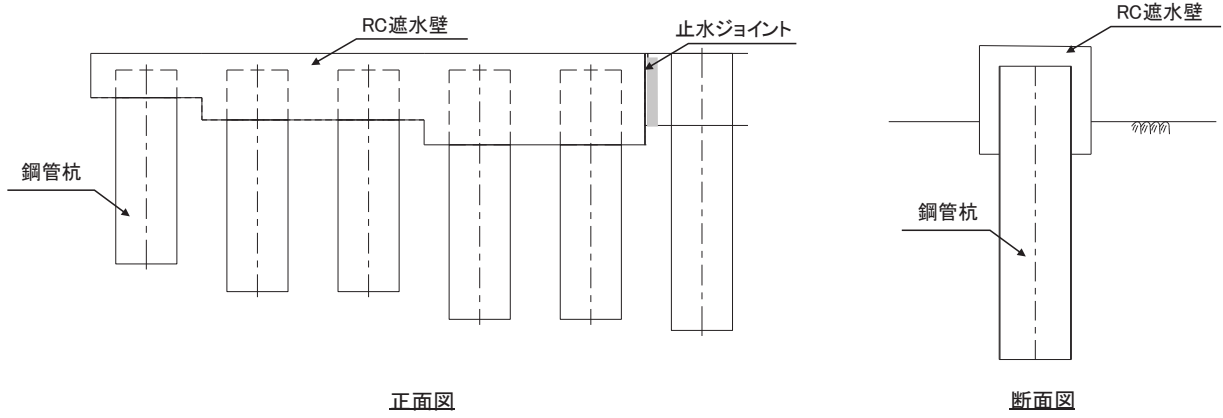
鋼管式鉛直壁（岩盤部） 正面図及び断面図（Ⅲ区間）
